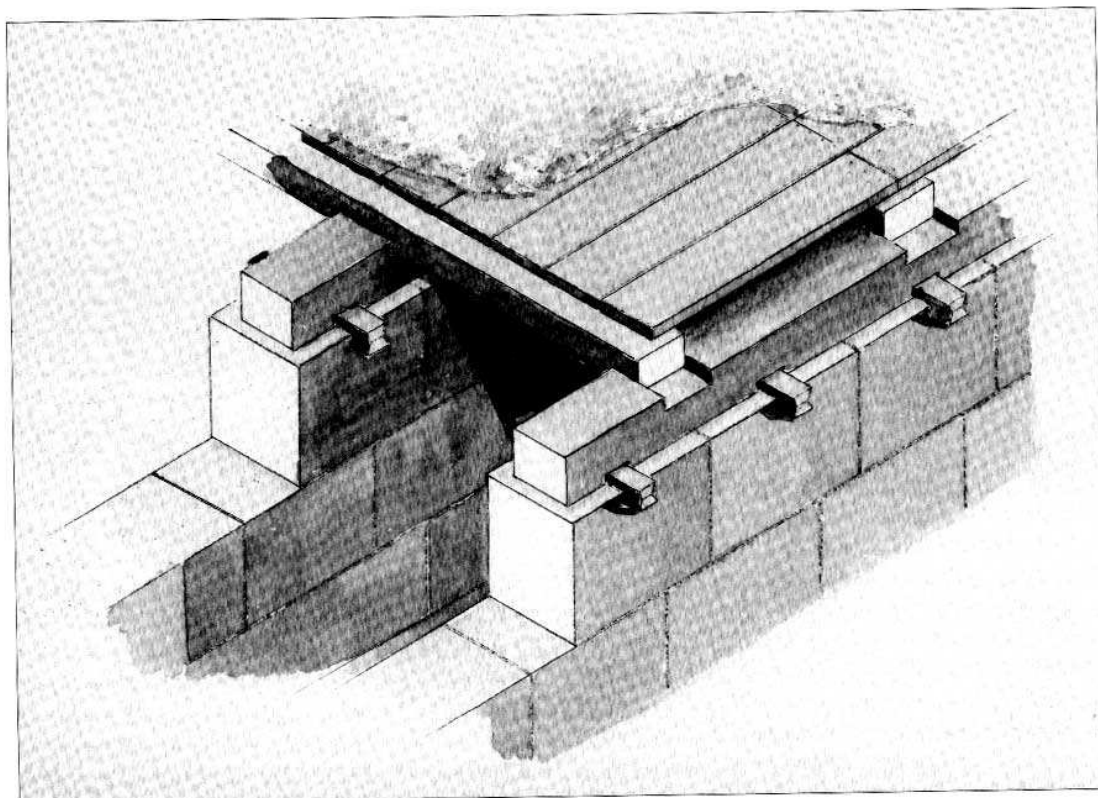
Ricostruzione del piano pavimentale dell'arena
